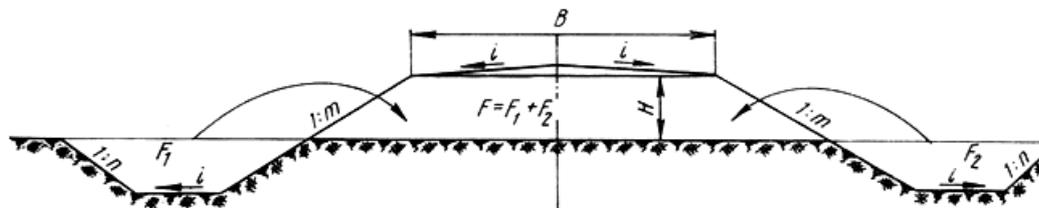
Возведение земляного полотна поперечным перемещением грунта бульдозерами из боковых резервов
